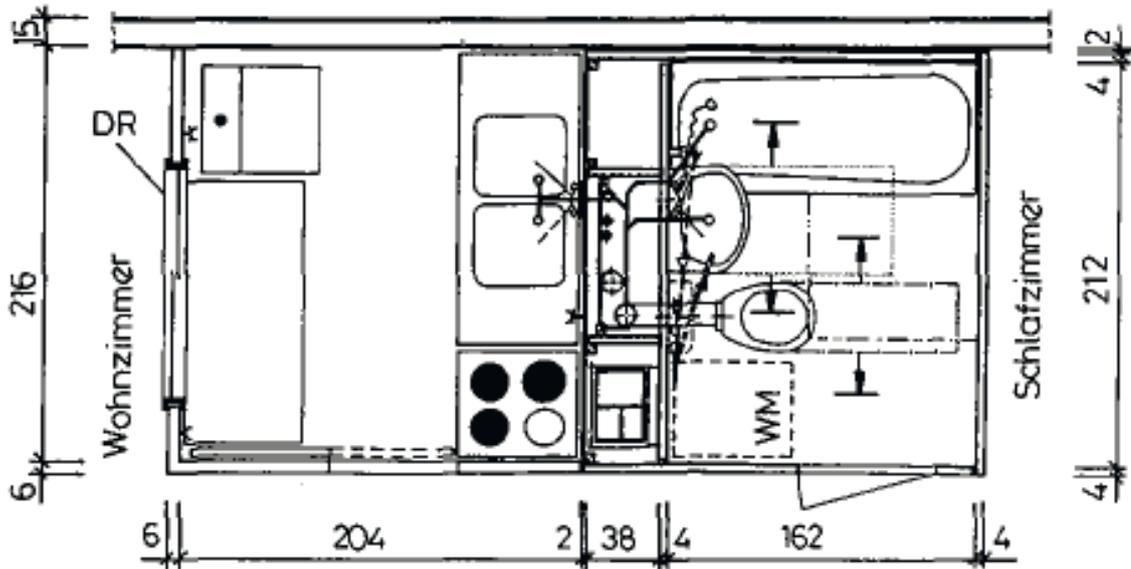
Installationsbereich in einem Plattenbau Typ WBS 70 (Oehler, 2000)
